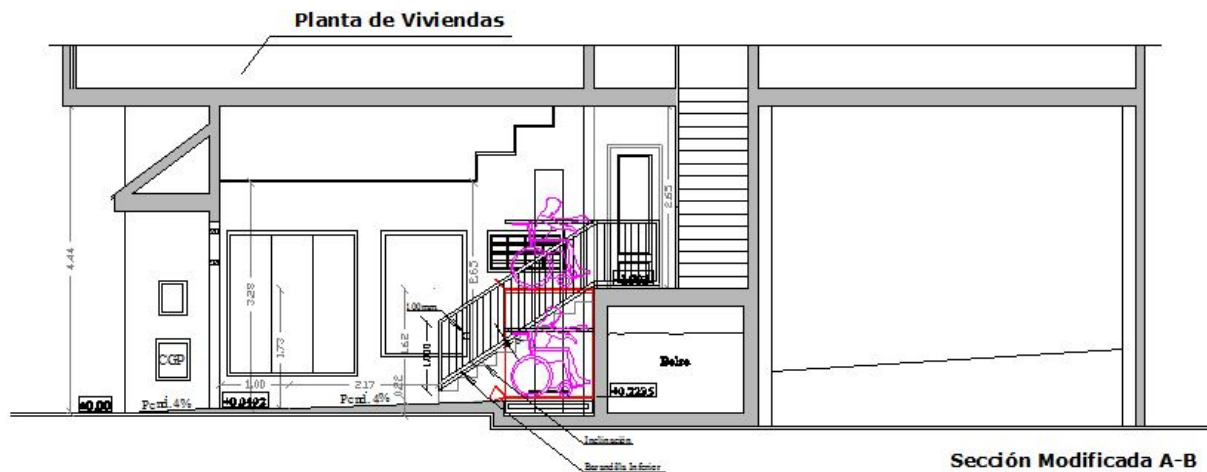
Accesibilidad, sección modificada [Anexo II. Planos]
